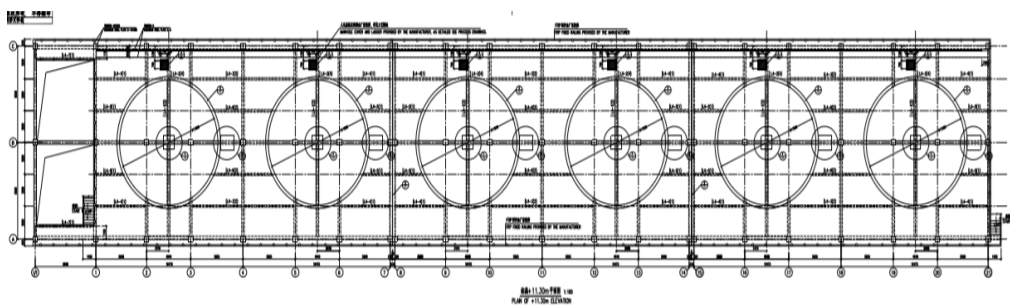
Planta do nível 11,80 m da torre de arrefecimento da CCC do Soyo.
